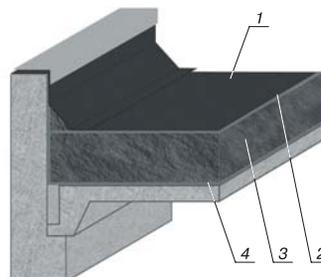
Теплоизоляция плоских кровель: 1 – наплавляемое полимерное покрытие; 2 – выравнивающий армирующий слой; 3 – «Эволит-термо»; 4 – пароизоляция
